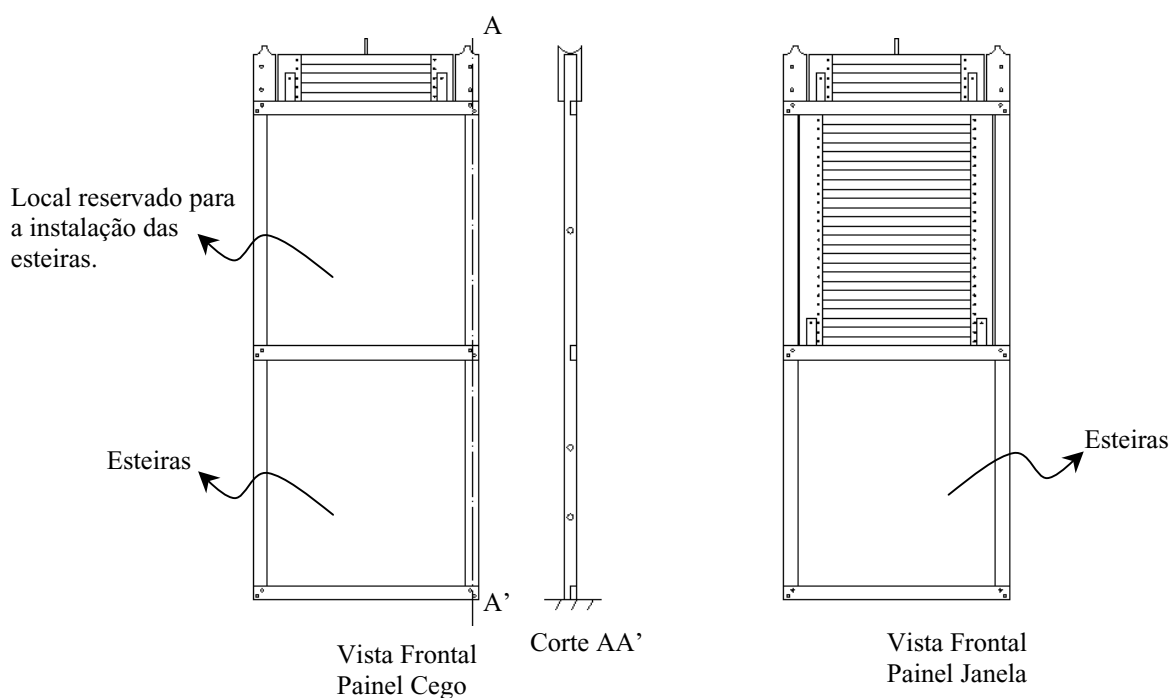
Concepção dos painéis cego e janela (vistas frontais e corte AA’).
